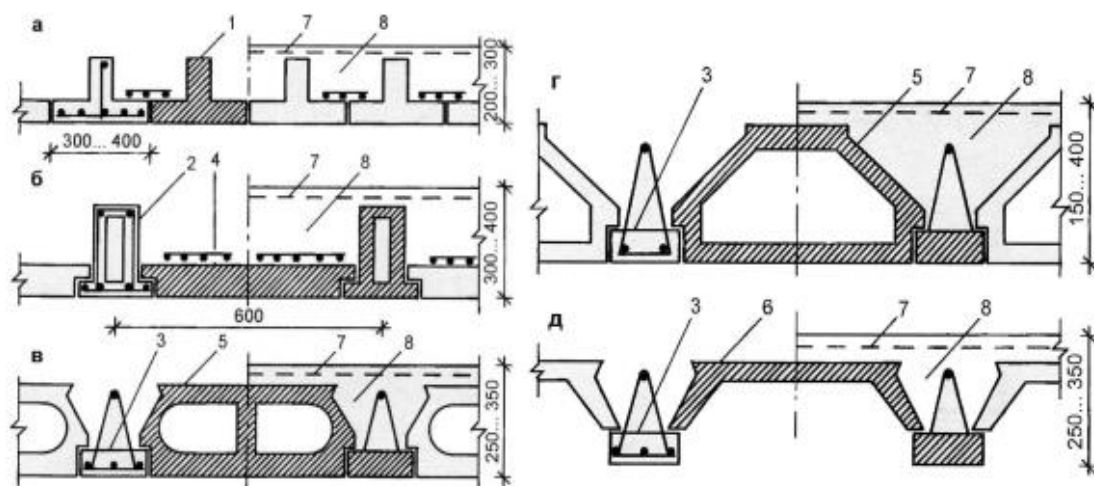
Сборно-монолитные перекрытия: а – с железобетонными балками таврового сечения; б – с пустотными балками; в, г, д – с балками с выпусками арматуры; 1 – тавровая балка; 2 – балка с нижними опорными полками; 3 – балка с выпусками арматуры; 4 – дополнительная рабочая арматура; 5 – пустотный блок заполнения; 6 – ребристая плита заполнения; 7 – арматурная сетка; 8 – монолитный бетон.
